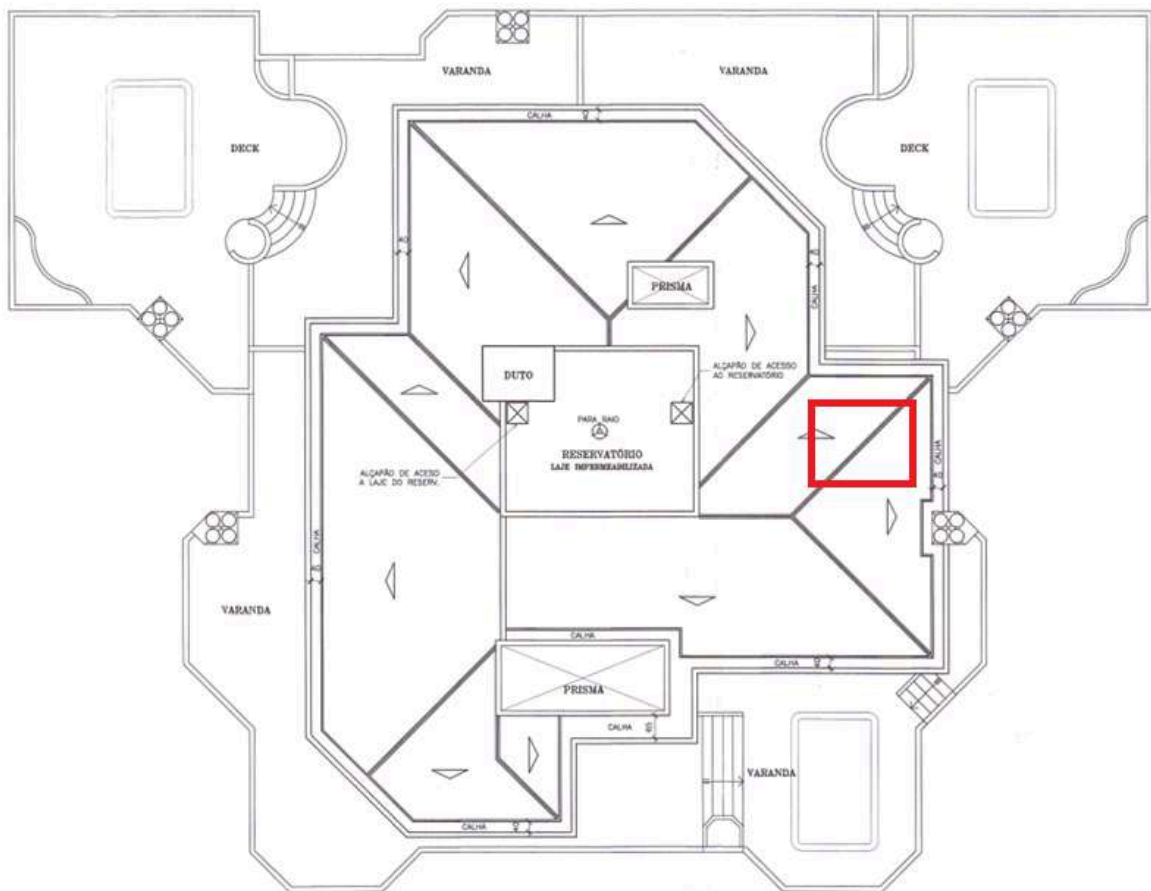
Indicação da localização em planta da ausência de cumeeira no telhado
